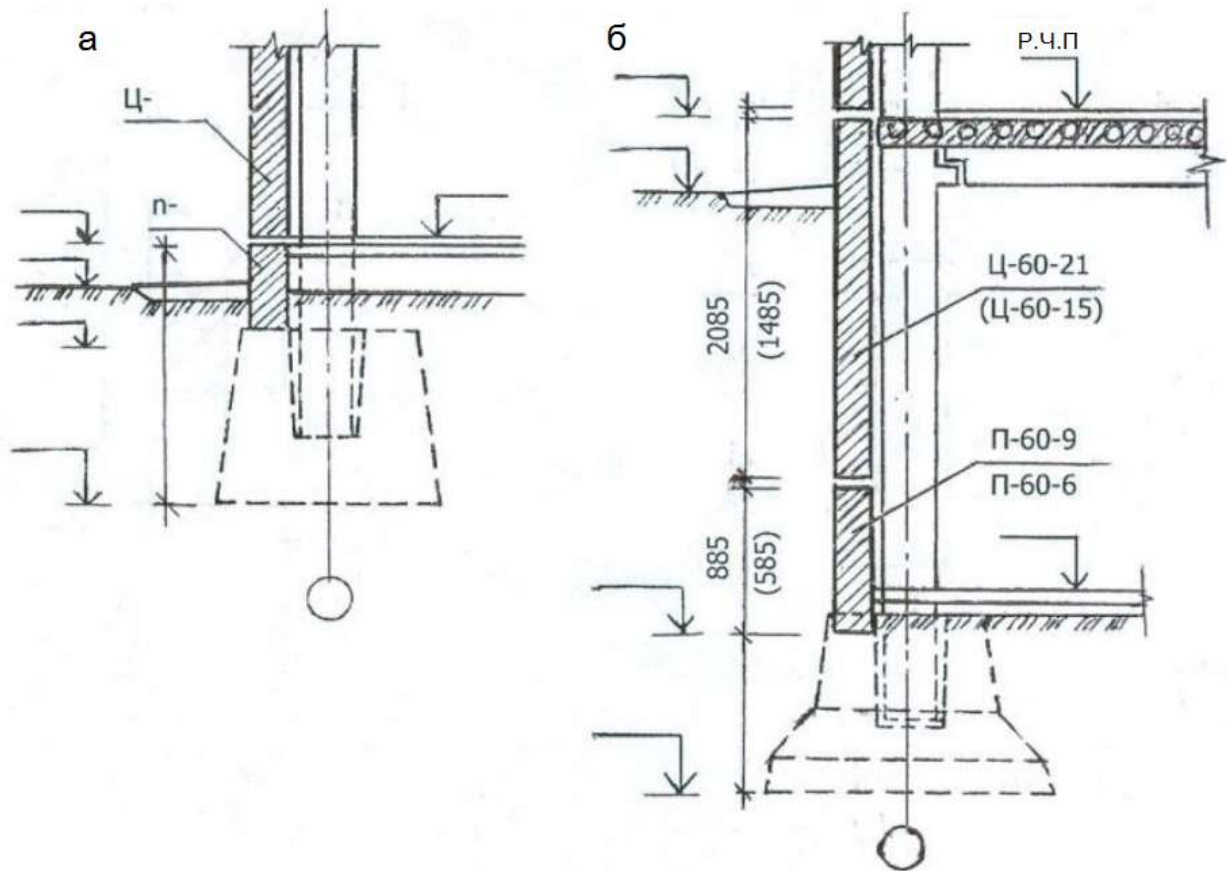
Стовпчастого типу окремо стоячі фундаменти каркасно-панельних будинків: а – без підвалу; б – з підвалом
